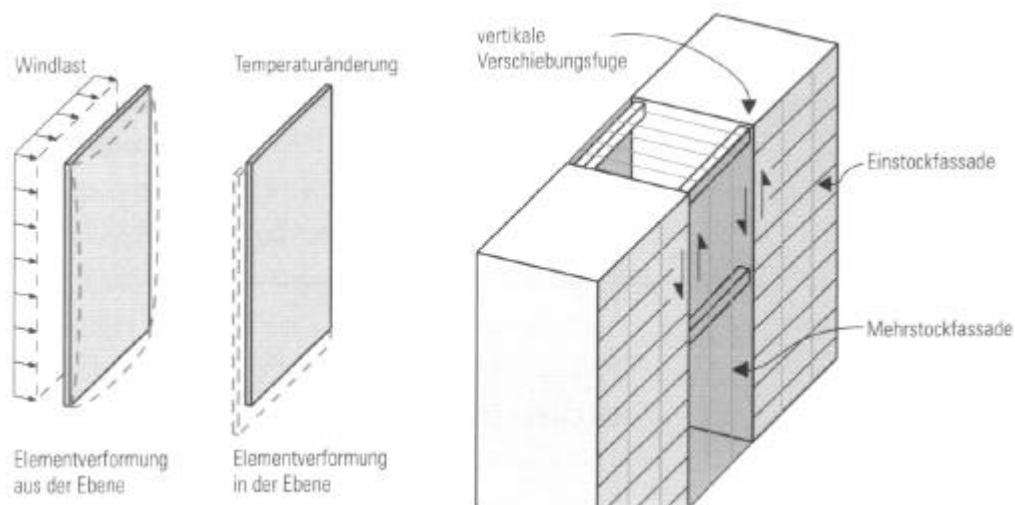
Elementverformungen und Abschnittsverformungen bei Fassadenkonstruktionen, Quelle: Hochhaus Atlas S. 149
